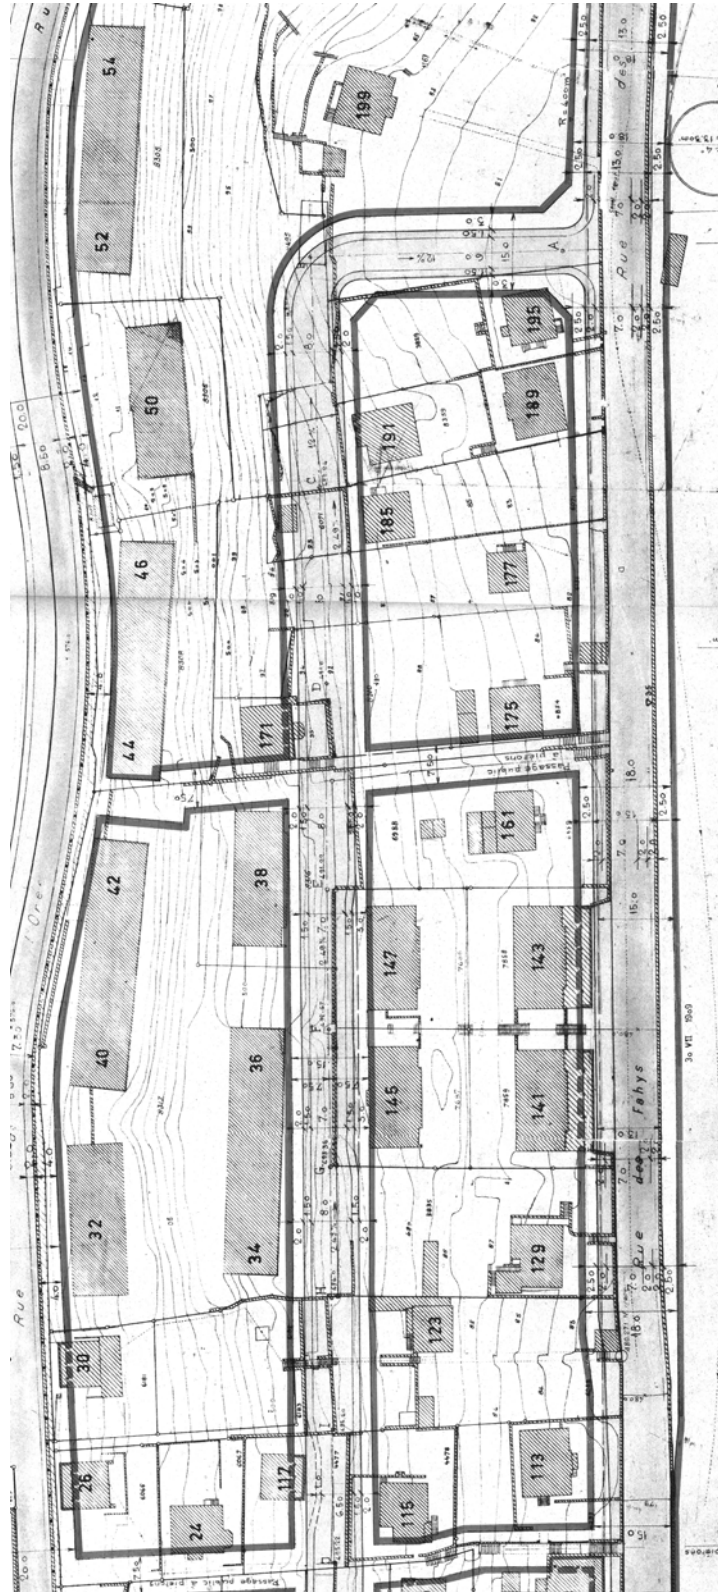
Plan d'alignement n° 85 du 17 mars 1970
